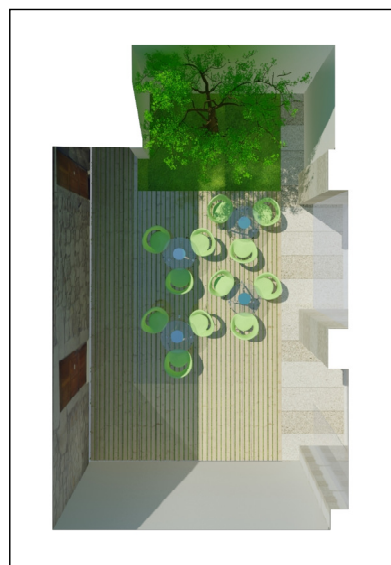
Planta 3d da esplanada (Anexo 3)
